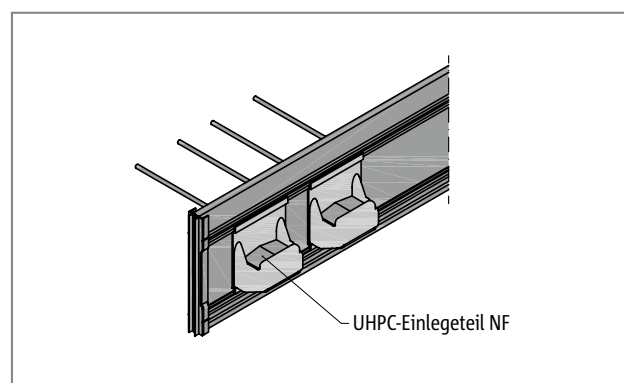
Schöck Tronsole® Typ T : Detail Tragkonsole negative Fertigung
